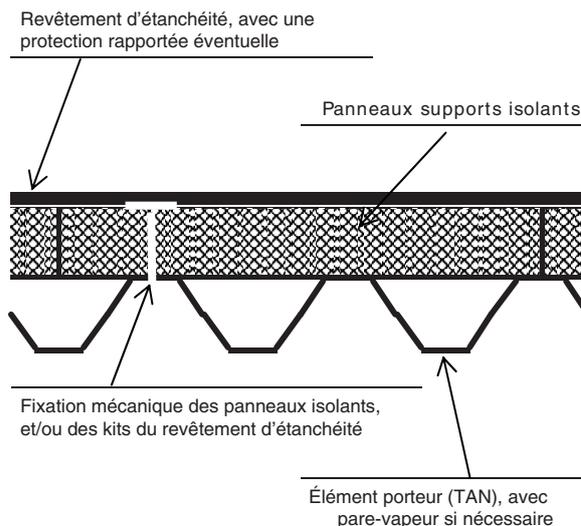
Coupe sur la toiture, avec une couche unique de panneaux isolants
